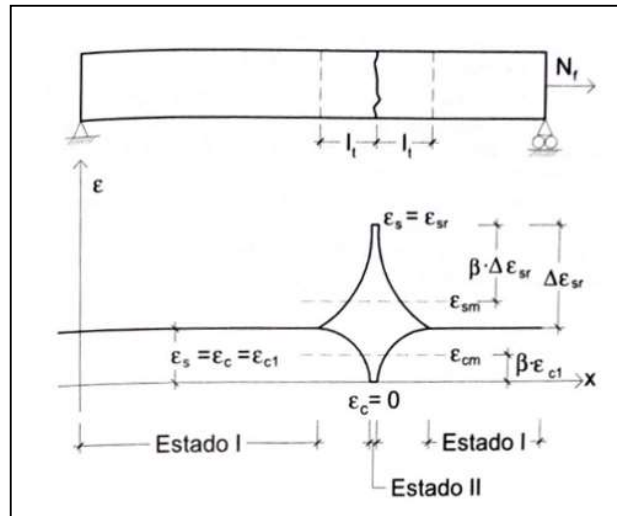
Formació de la primera fissura (Font: Jiménez Montoya, 2009)
